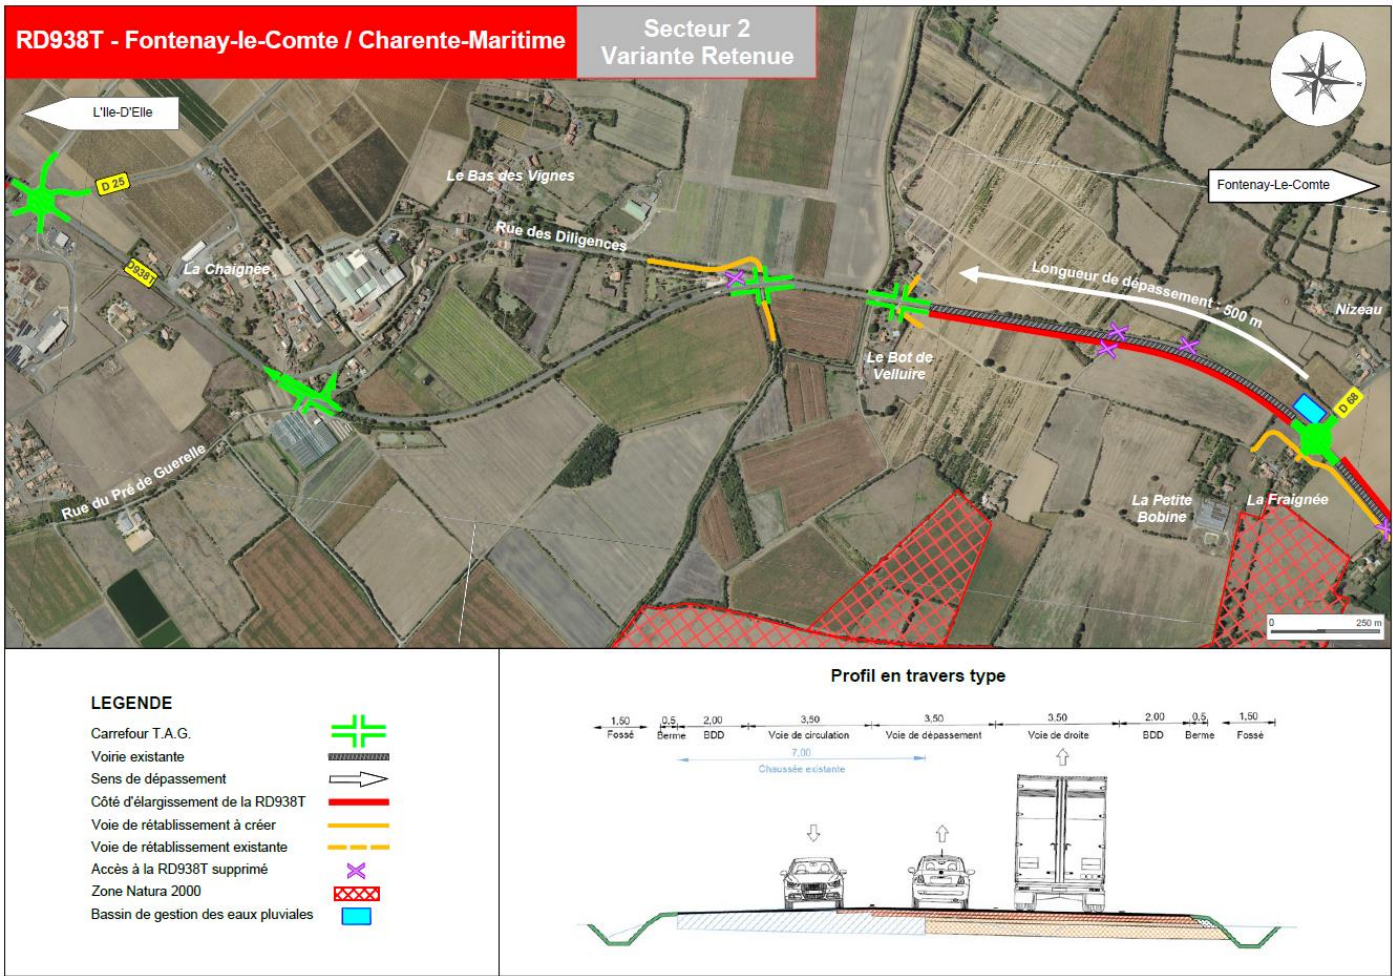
Plan simplifié du secteur 2 (Source : Iris Conseil)
